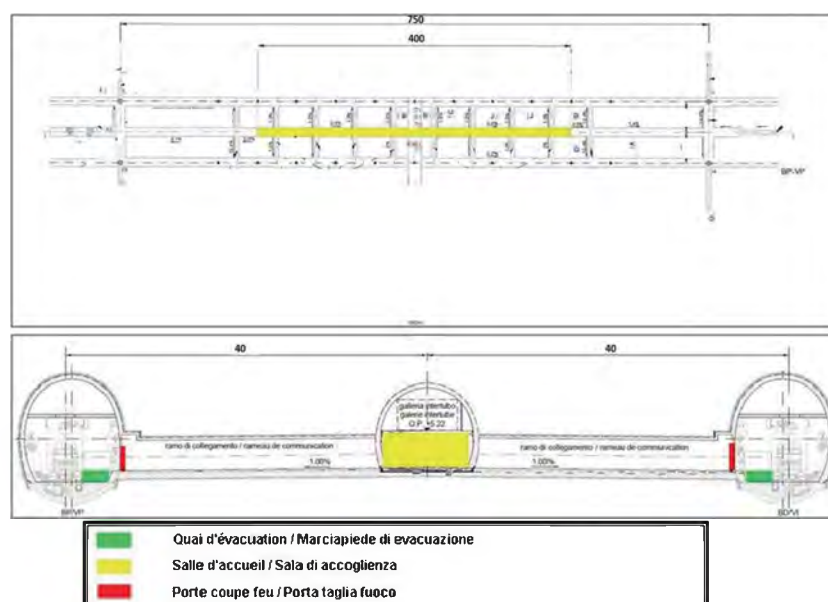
Area di sicurezza sotterranea – Pianta e sezione.
